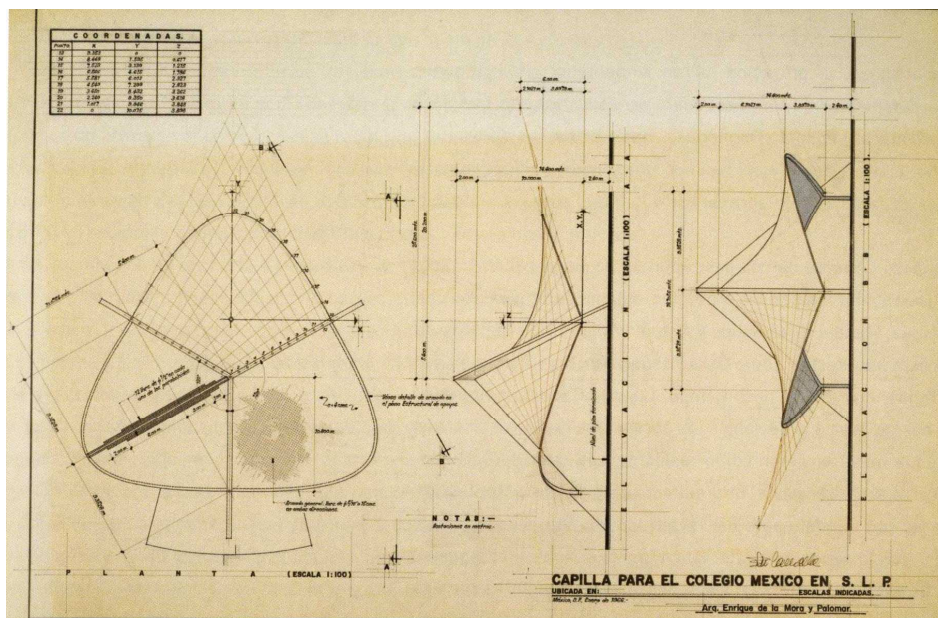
Plano de plantas y alzados, Colegio México, Aberly Library, Columbia University.
